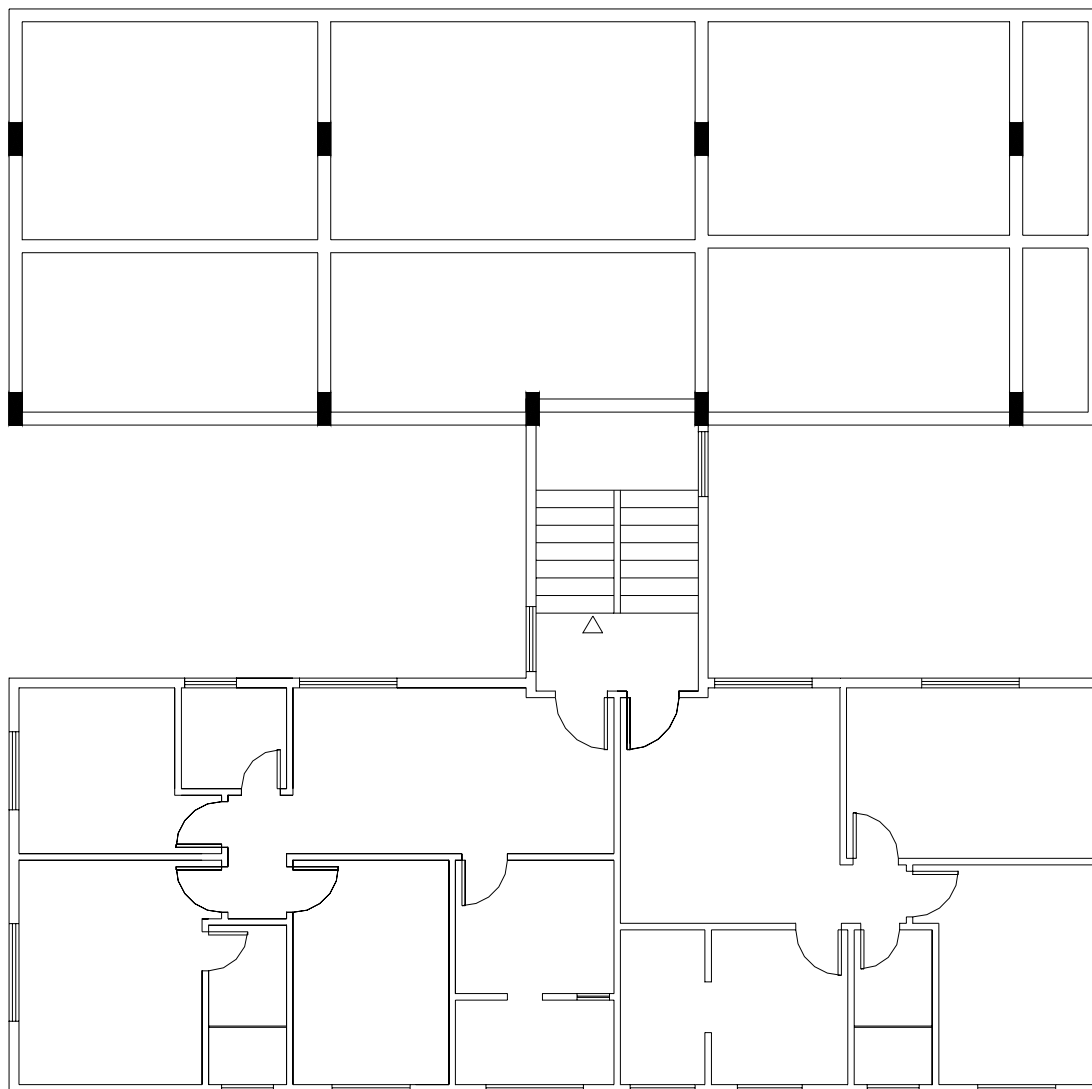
Residencial “S” – Primeira solução de vigamento do pilotis
